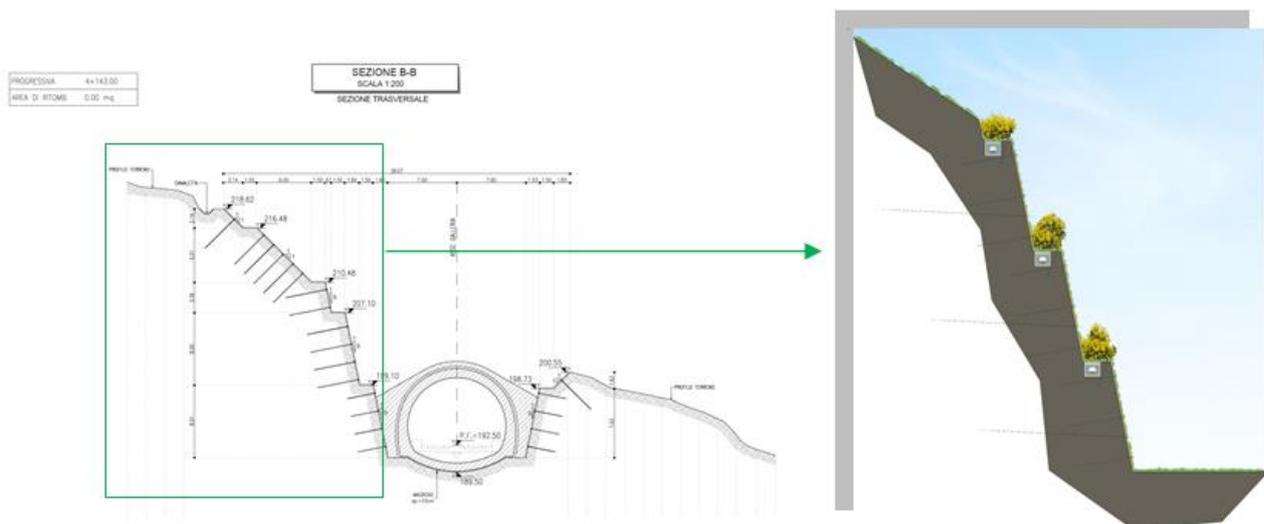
Stralcio della tavola GALLERIA PONTE CHIARODOVO GN04 – IMBOCCO LATO PM228 Sistemazione definitiva – Sezioni caratteristiche – IROP02R07W9GA0700001A, allegata alla presente, e con sezione dell'applicazione dell'inerbimento dell'area superiore dell'imbocco
